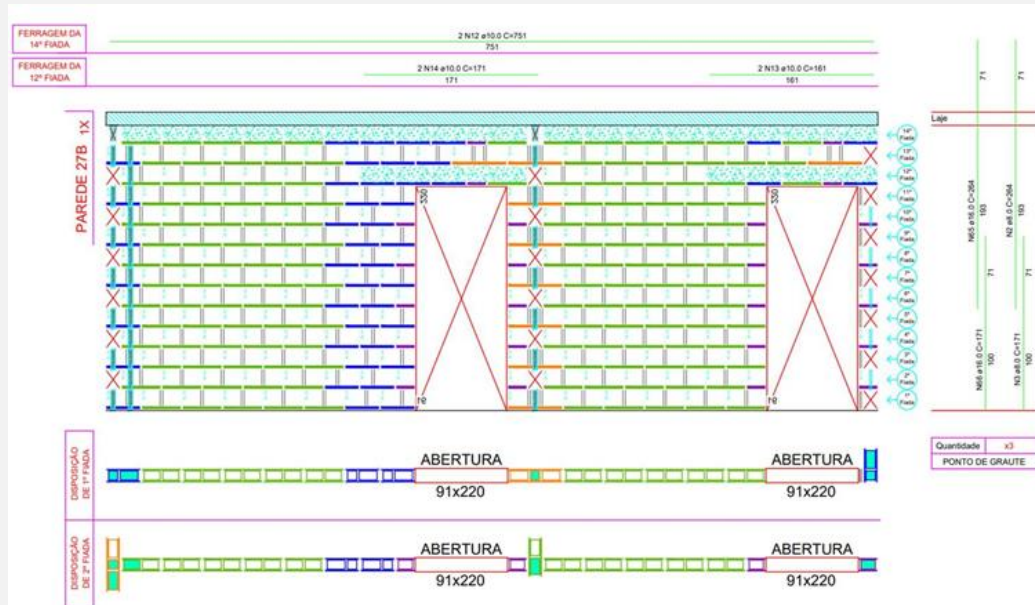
Elevação da parede 27B. Fonte: Autores.
